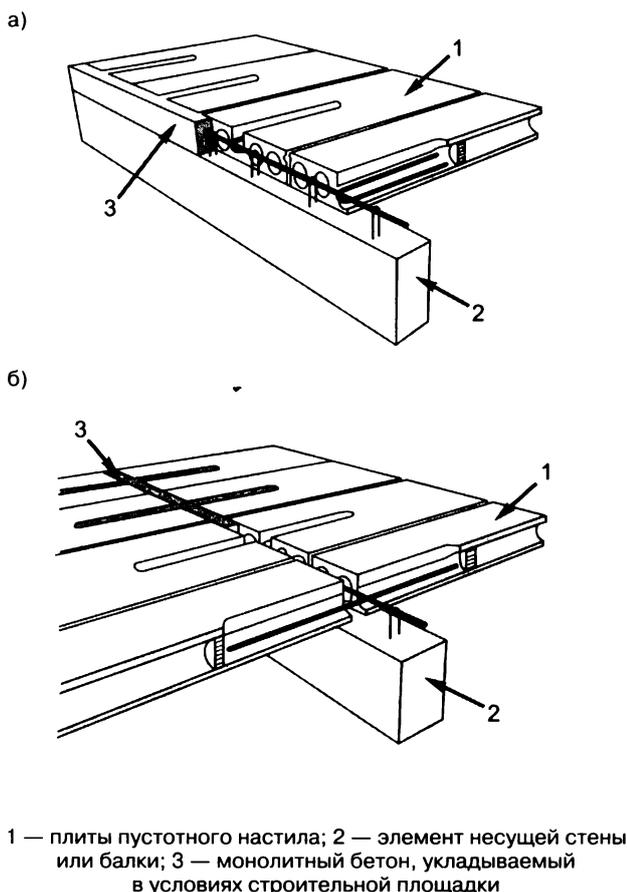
Принципиальные схемы устройства периметрических (а) и вертикальных (б) связей в перекрытиях из плит пустотного настила
